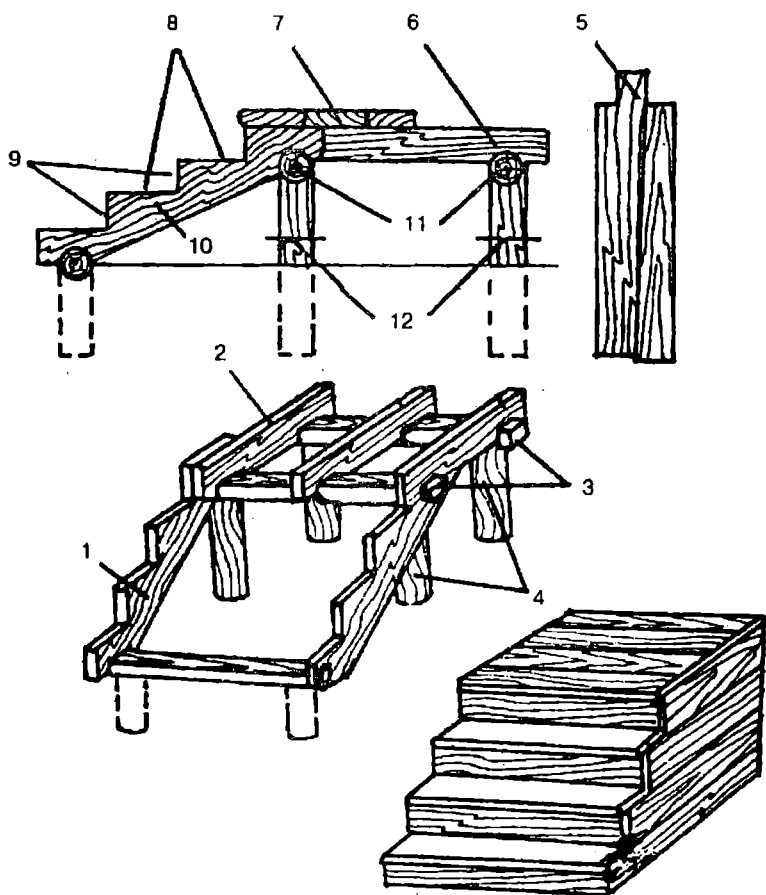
Вариант деревянной конструкции лестницы для крыльца:
